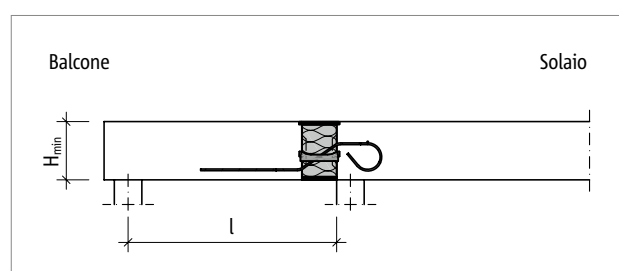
Schöck Isokorb® XT tipo QL: schema statico (XT tipo QL-V1 - V4)
